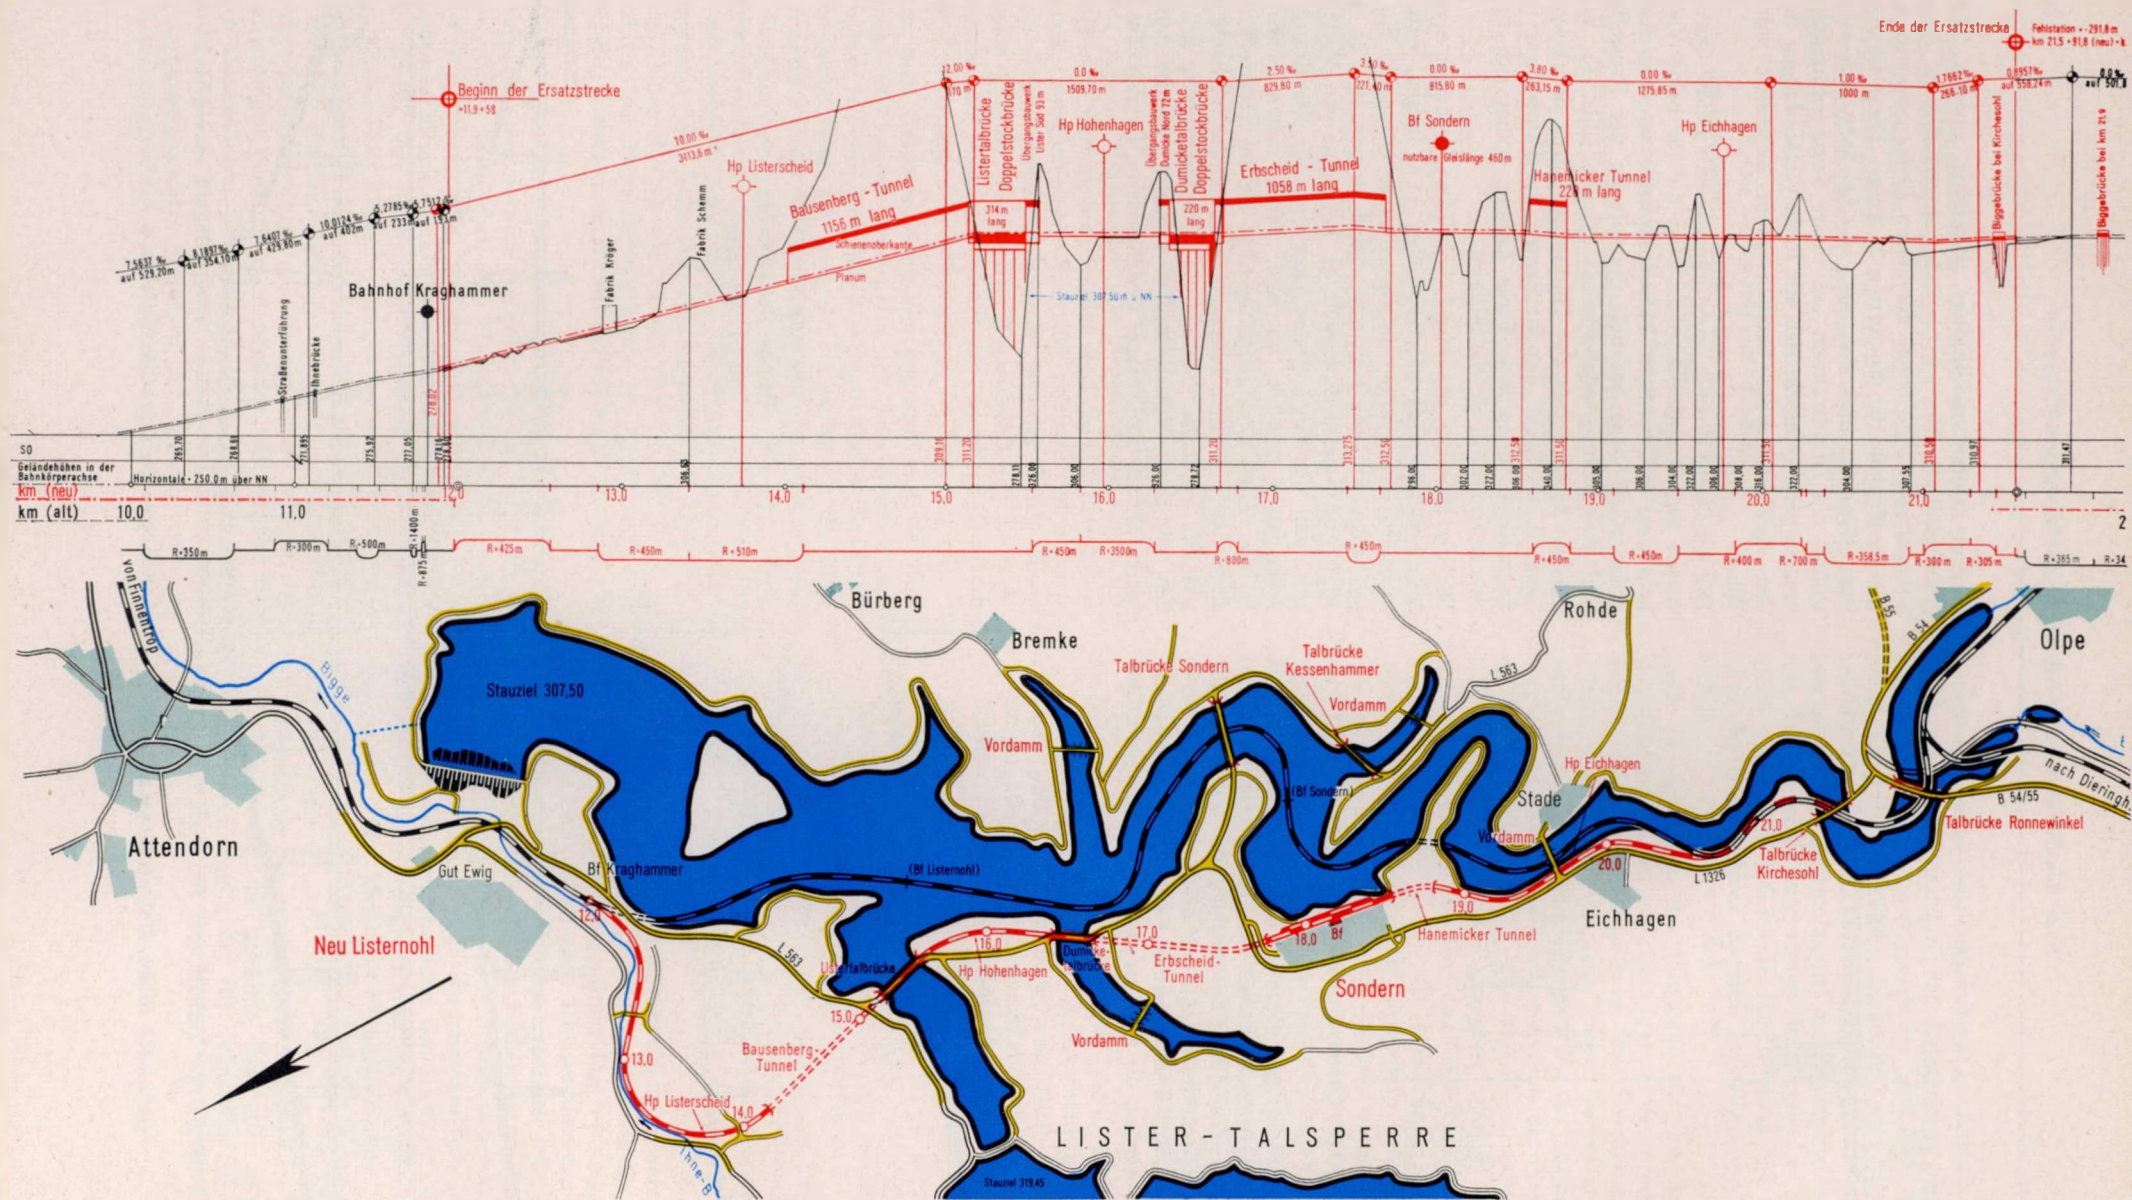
Lageplan der alten und der neuen Strecke an der Bigge mit Längsprofil
